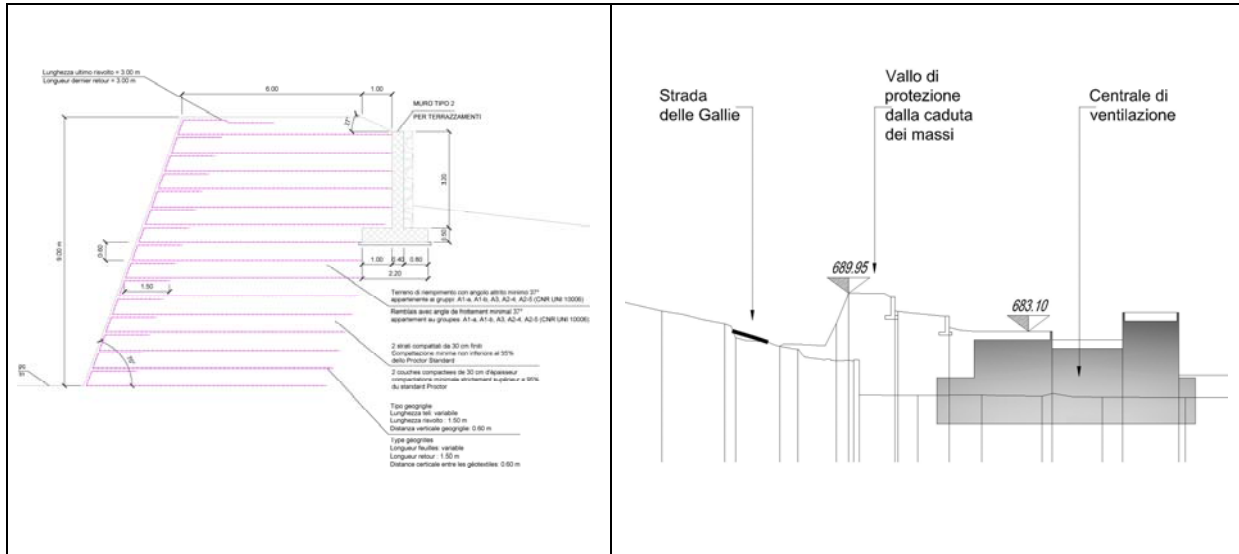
Rilevato paramassi – sezione tipologica terra rinforzata e sezione tipo sistemazione di valle
